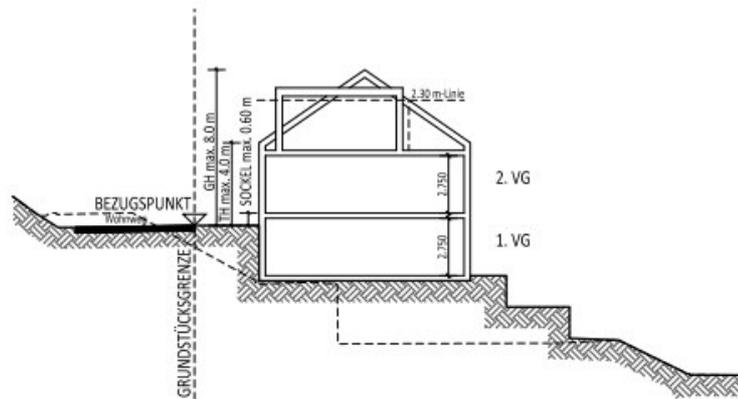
Entwurf des Bebauungsplans Nr. BS 08 „Seegenberg“ (U2.6 mit Ergänzungen)
